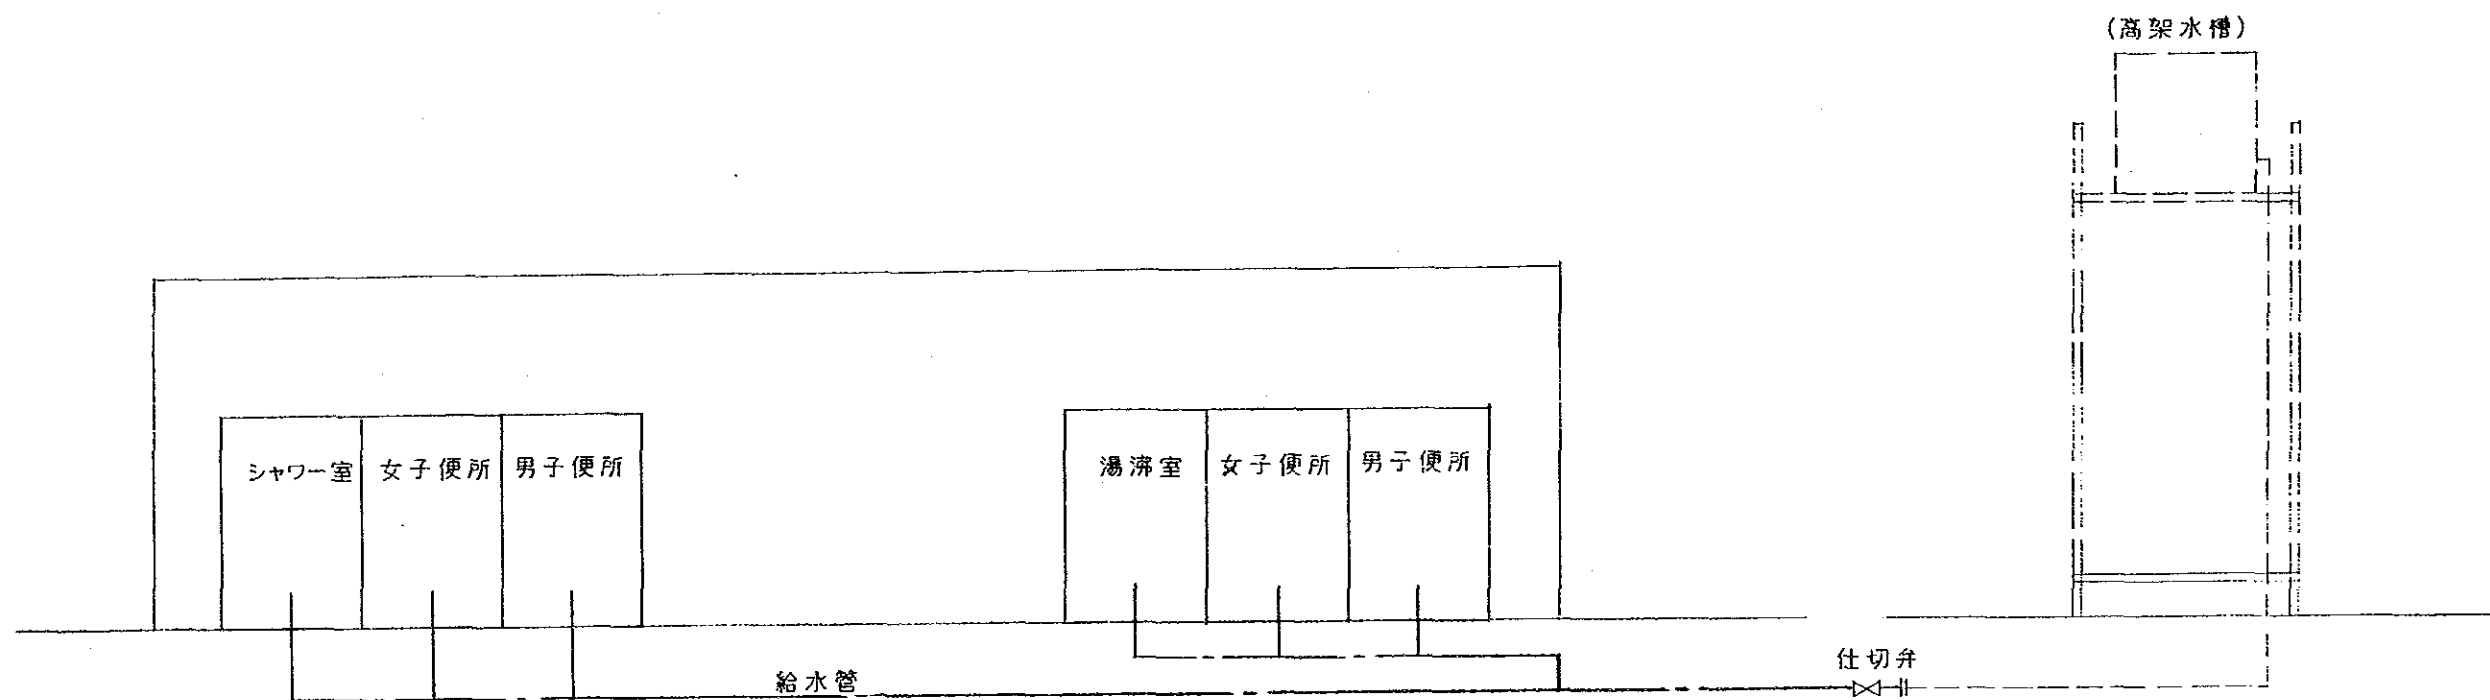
スリランカ公開大学AV教育センター断面図 1:200
